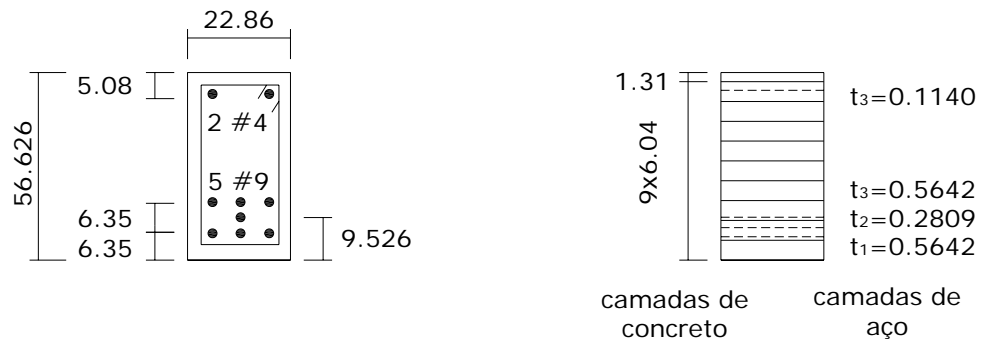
Geometria e seção transversal das vigas A-3 e B-3
